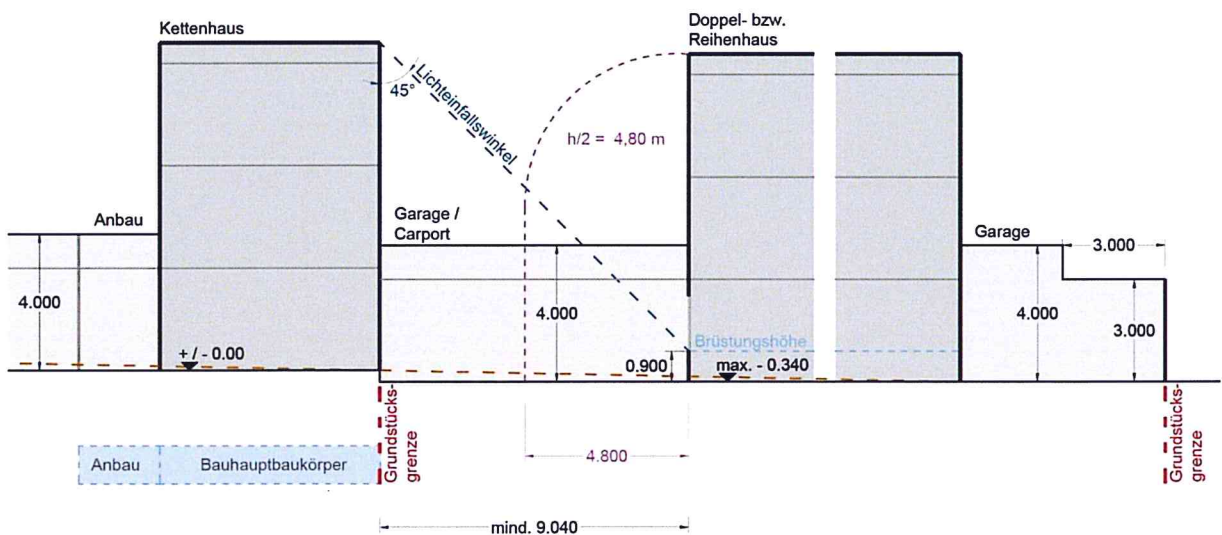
Schnittansicht Kettenhaus/ Doppel- bzw. Reihenhaus – Garage/ Carport bauliche Verbindung zwischen den Bauhauptkörpern, o. M.
